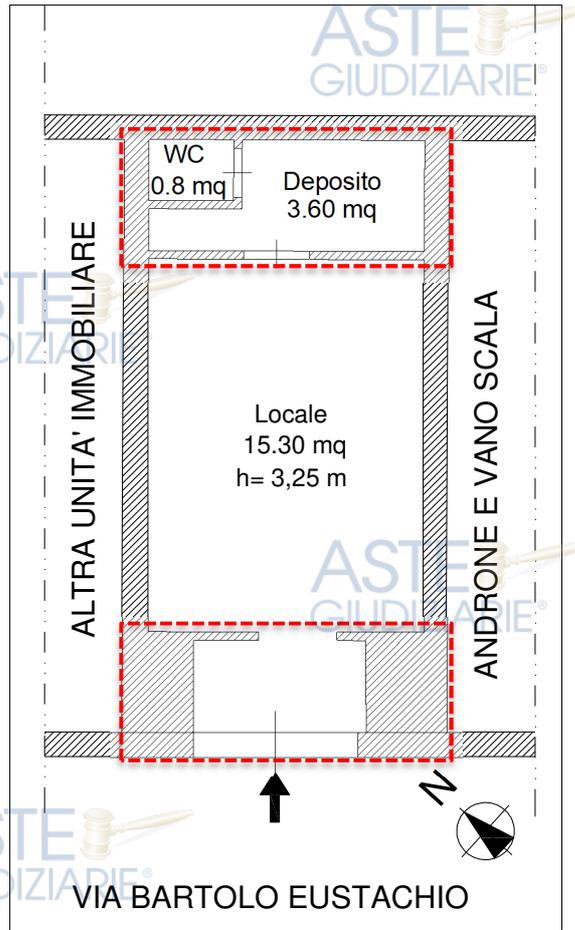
Pianta del locale commerciale pignorato – piano terra (Lotto 4)
